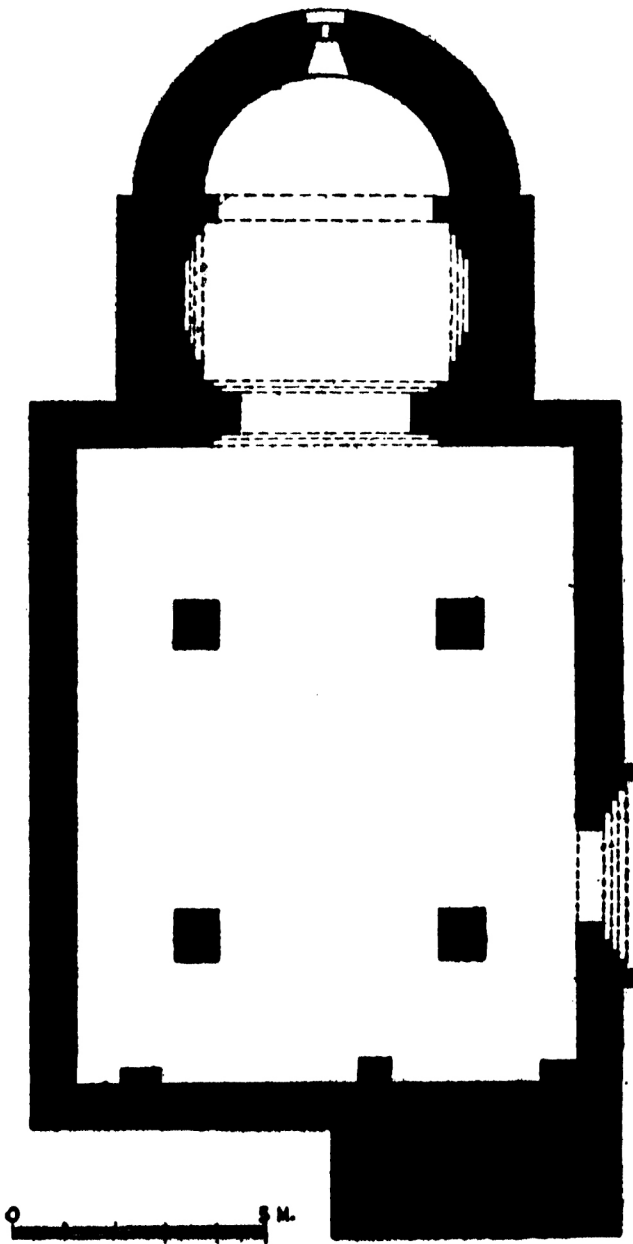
Carabanchel (Madrid)*. — Ermita de Santa María la Antigua. Planta.
